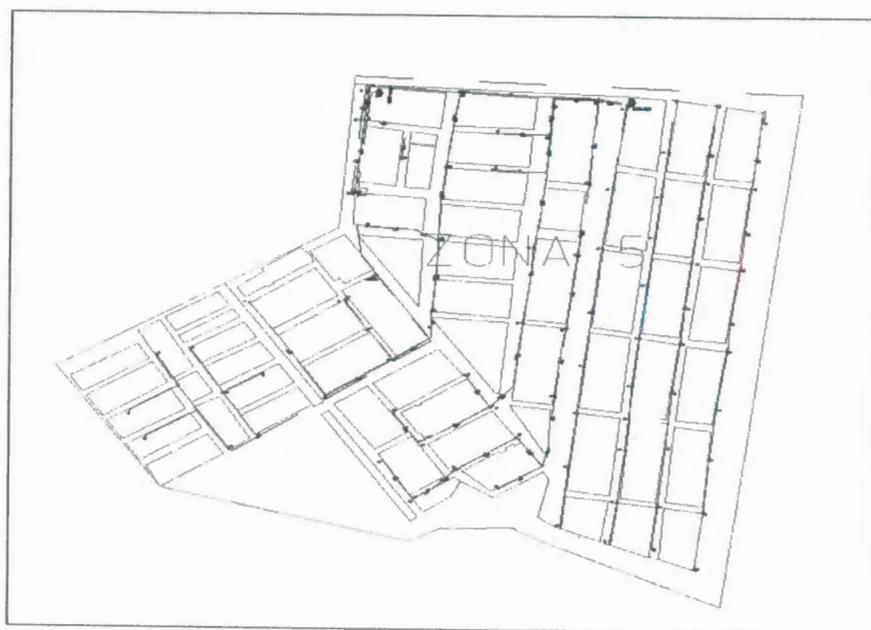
Planimetría zona 5 del sector de la vía a Daule
